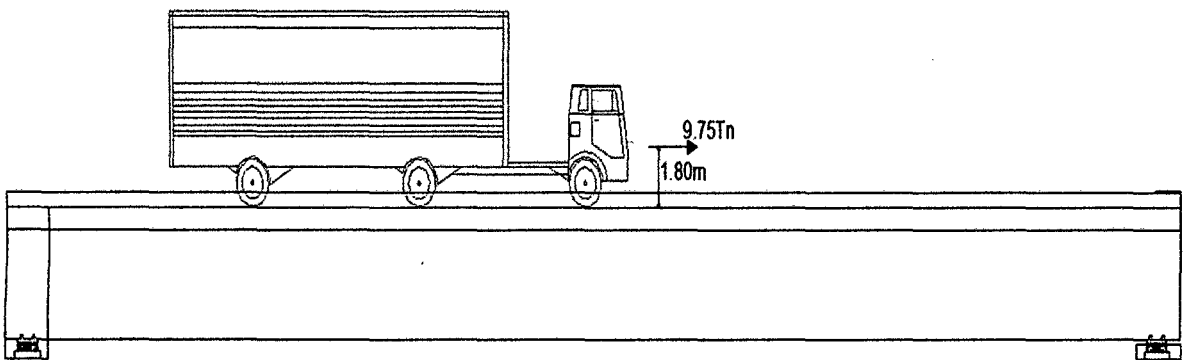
Acción de la Fuerza de Frenado – Camión de Diseño HL-93 - Para el Primer y Tercer Tramo.
